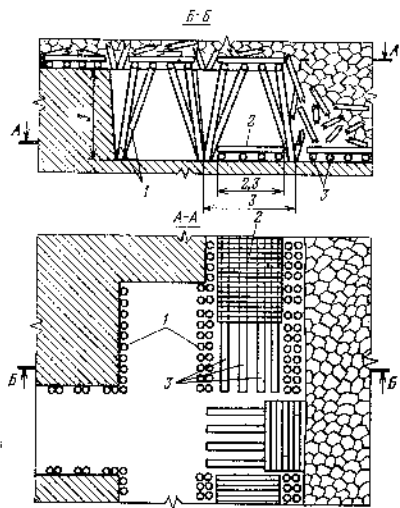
Слоевое обрушение с выемкой руды под перекрытием на четырех прогонах:
